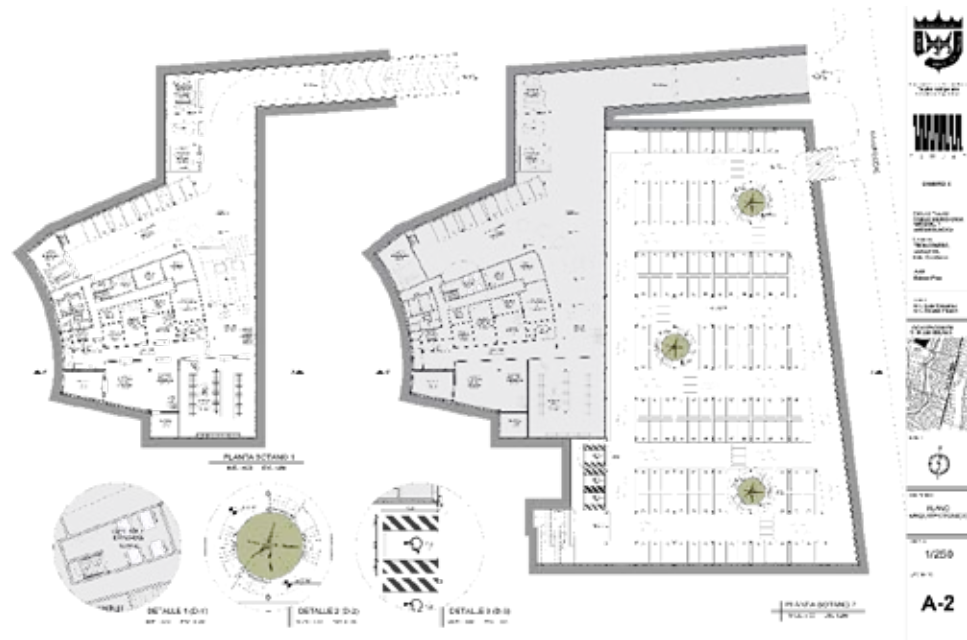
Planta Sotano 1 y 2 - Detalles. Fuente: Autor (2021)
